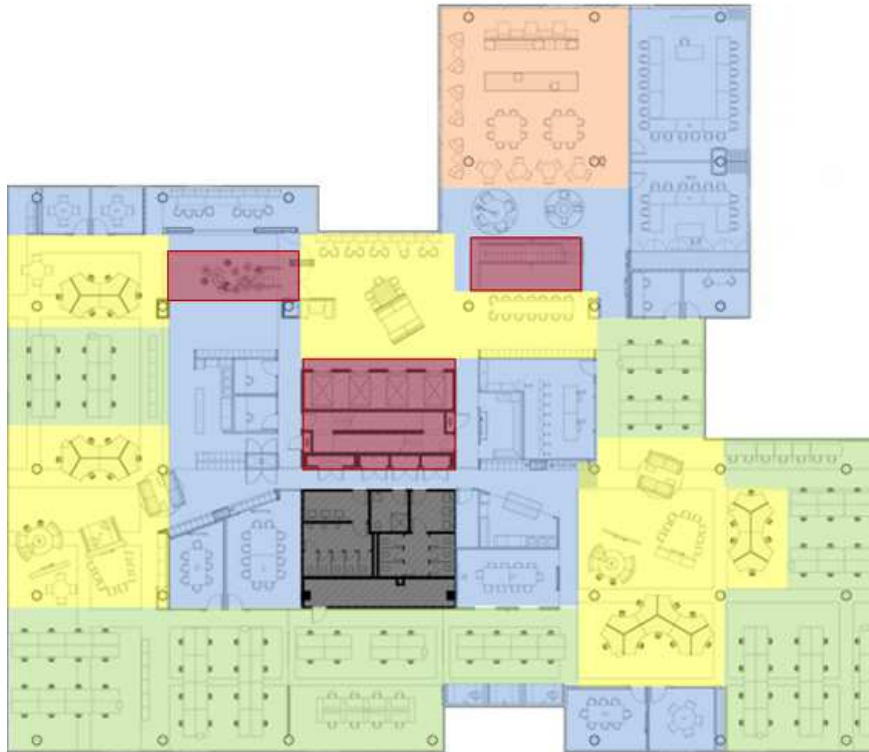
Planta baixa do segundo pavimento editada pela autora.
